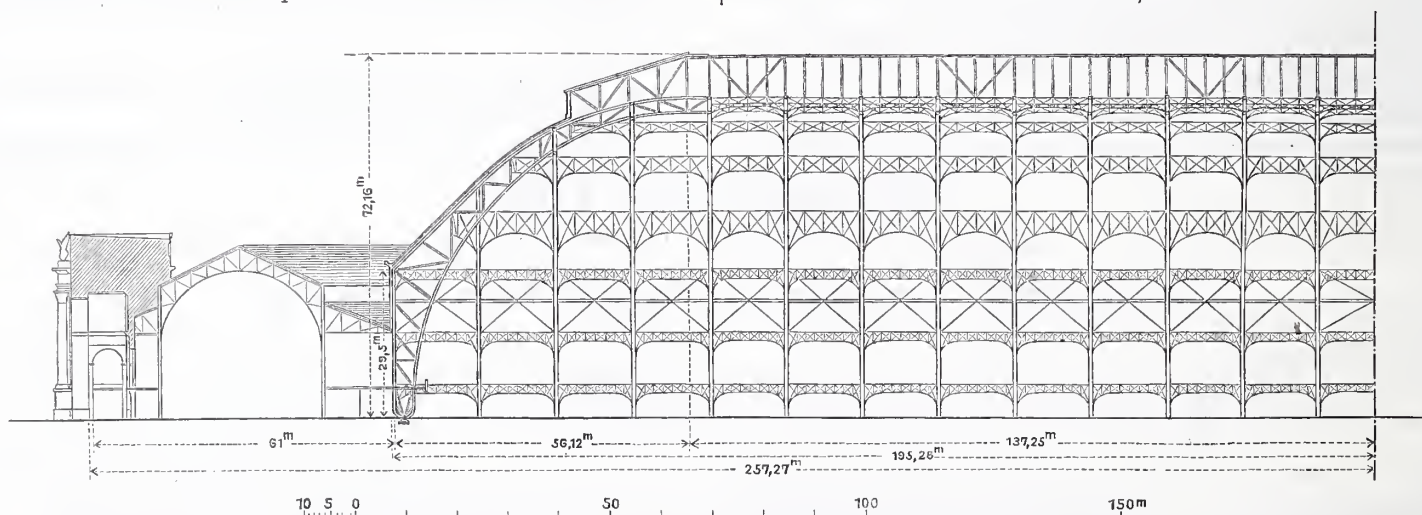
Haupt-Gewerbehalle. Längenschnitt.
